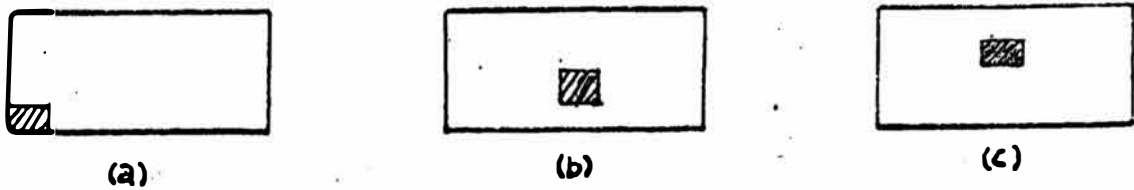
Diferentes posiciones de un arranque en un frente
